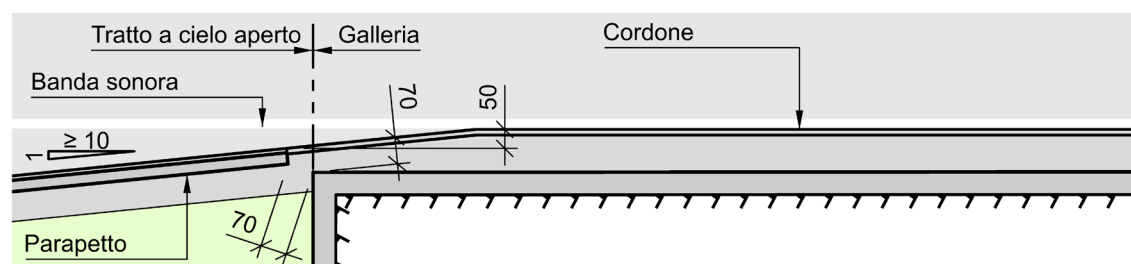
Variante 3b – Il muro guida termina prima del portale della galleria
